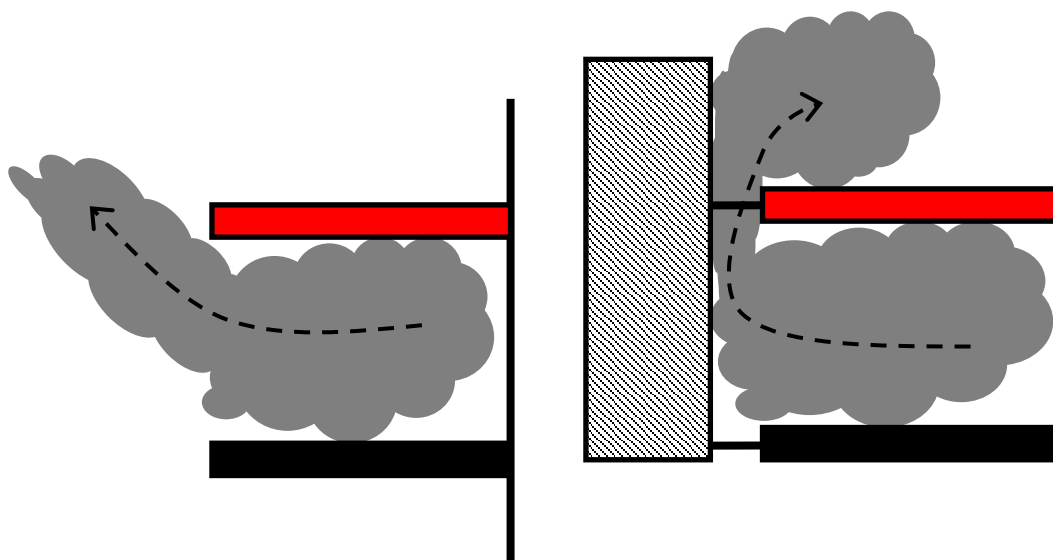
; Ett exempel på hur en extern installation kan generera en luftkanal mellan installation och den befintliga konstruktionen.
